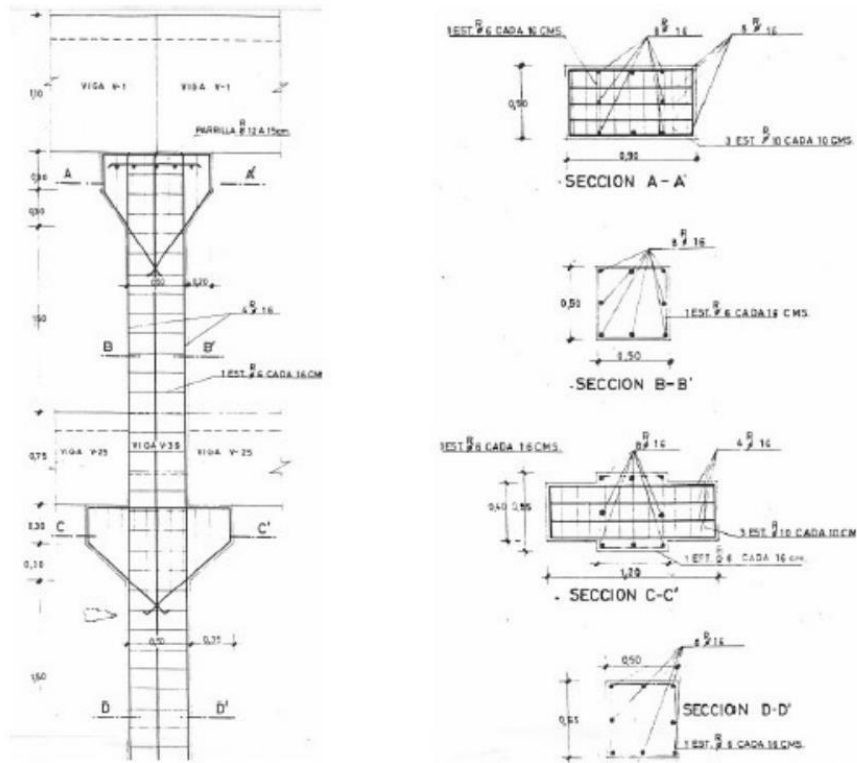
Detalles de sección de armado de pilares y ménsulas dobles de las plantas -1 y -2 del aparcamiento
